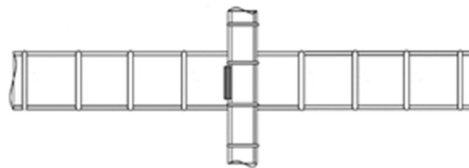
Fragmento de barra soldado a barra longitudinal
